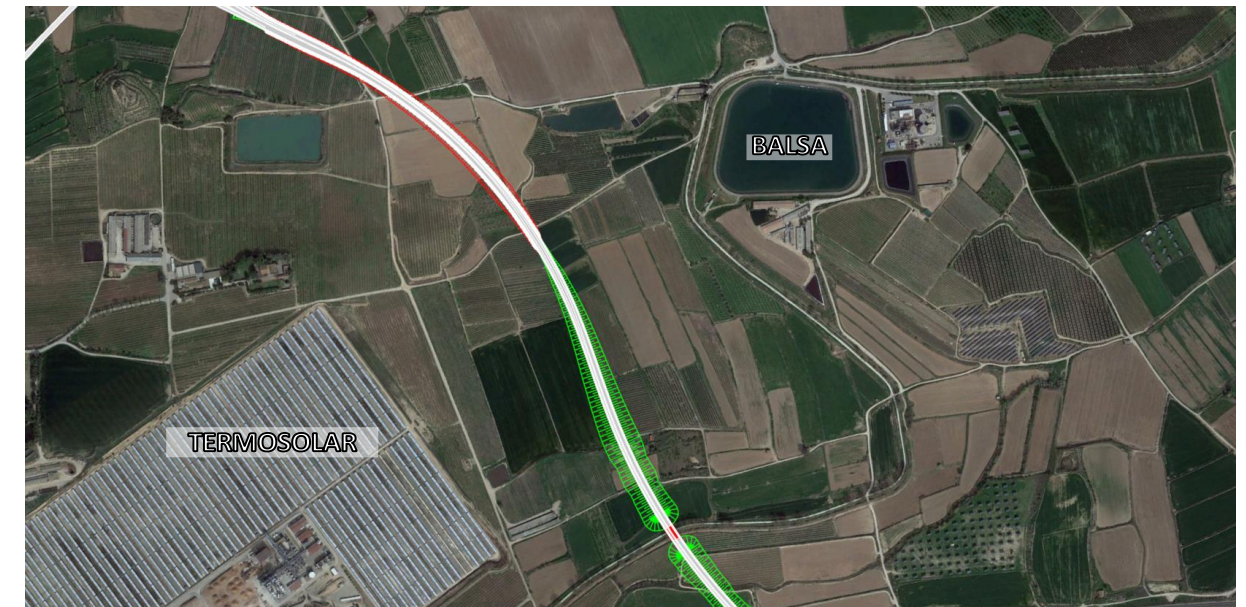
Detalles del trazado sorteando zona de paneles y balsa. Alternativa D3
